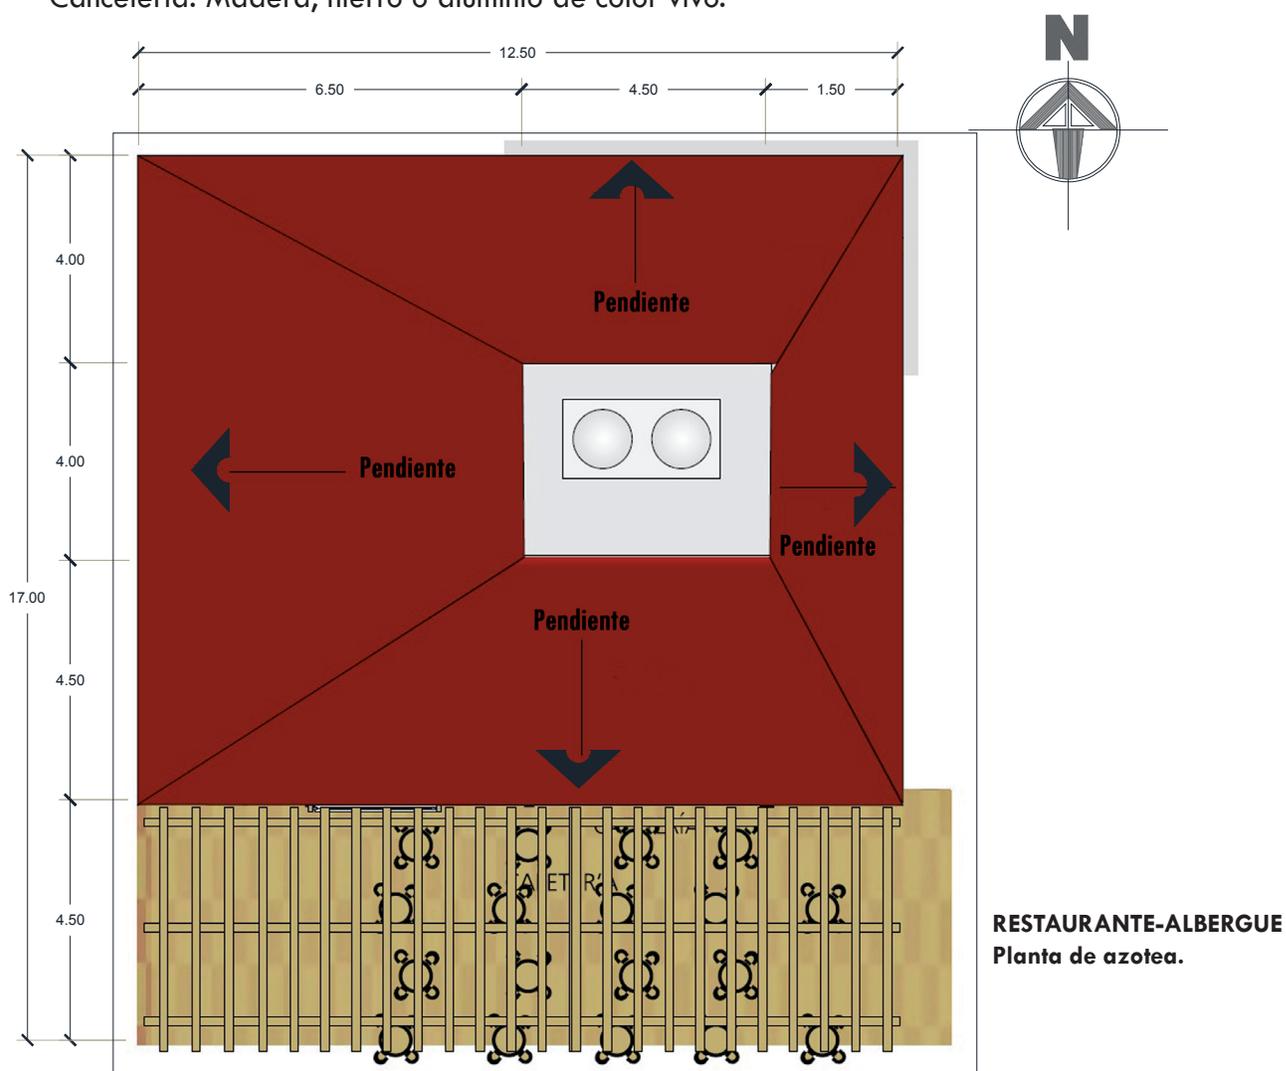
| Ejemplo de una planta de azotea de un restaurante-albergue para un complejo ecoturístico.³⁸
